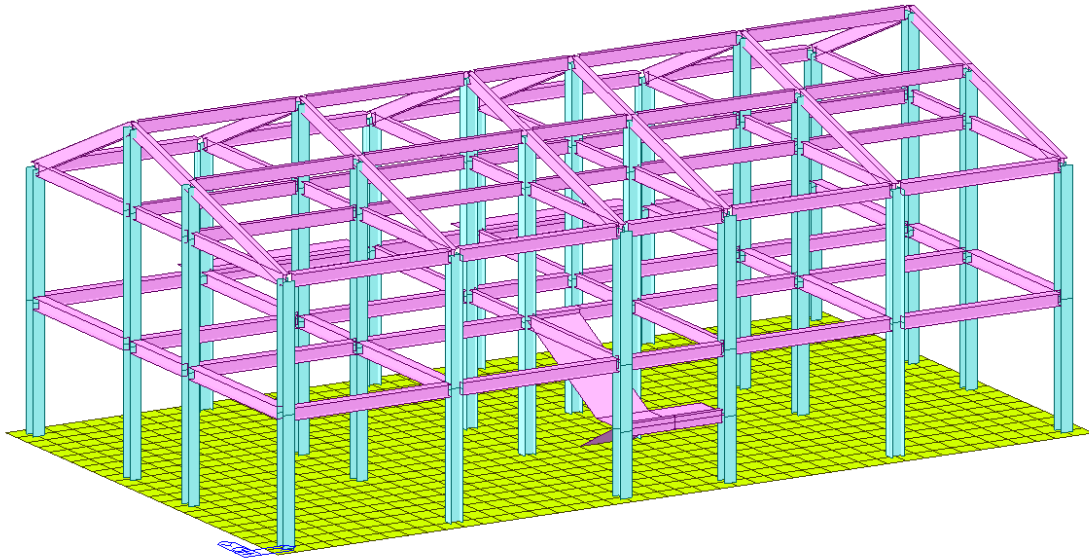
Modello FEM edificio a due piani in acciaio con platea di fondazione - Vista assometrica 1.
